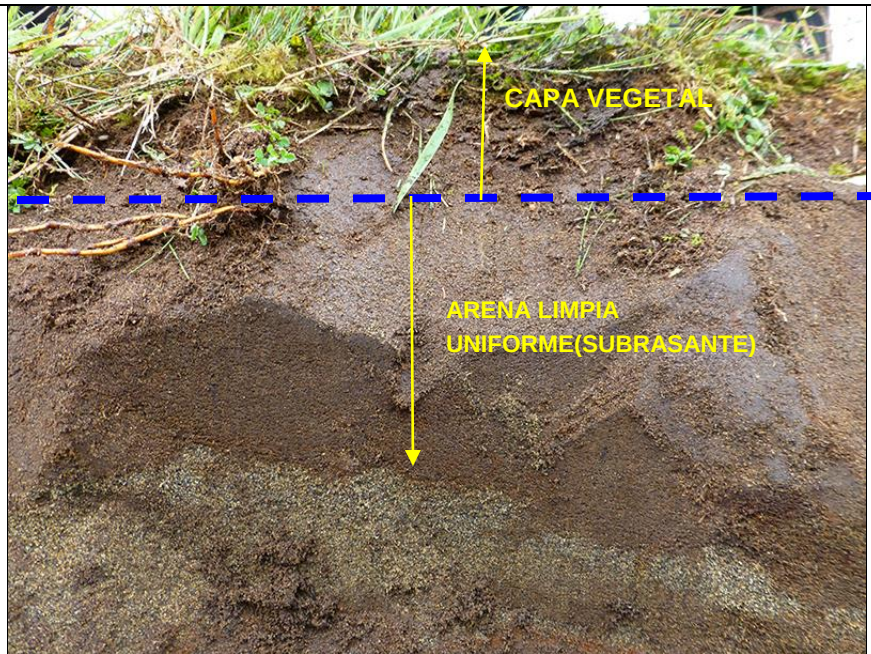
SECCIÓN TRANSVERSAL EN SECTOR CERCANO A PISTA.
